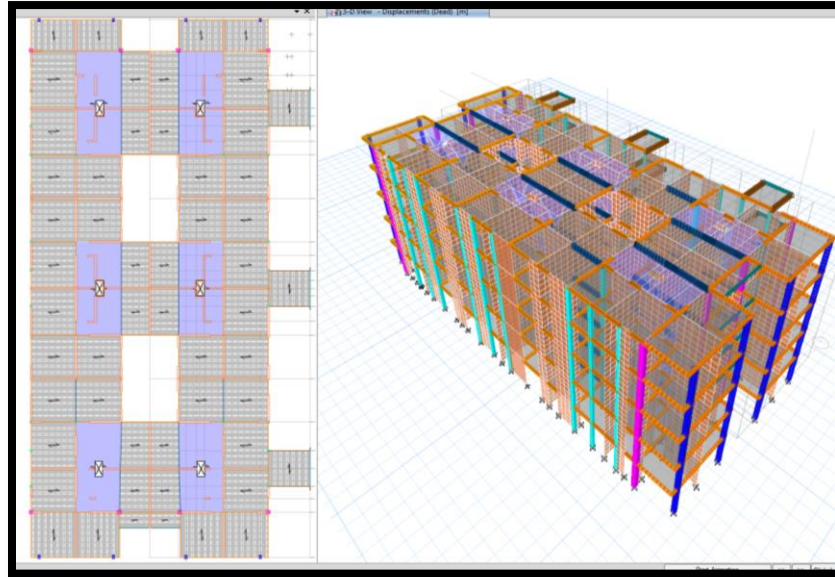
Vista de Modulo 02 (Sistema de Muros de Albañilería Confinada)
